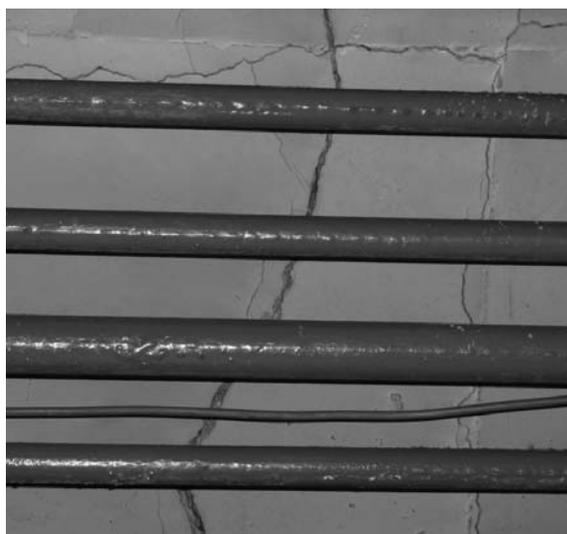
Сквозная трещина в плите перекрытия
